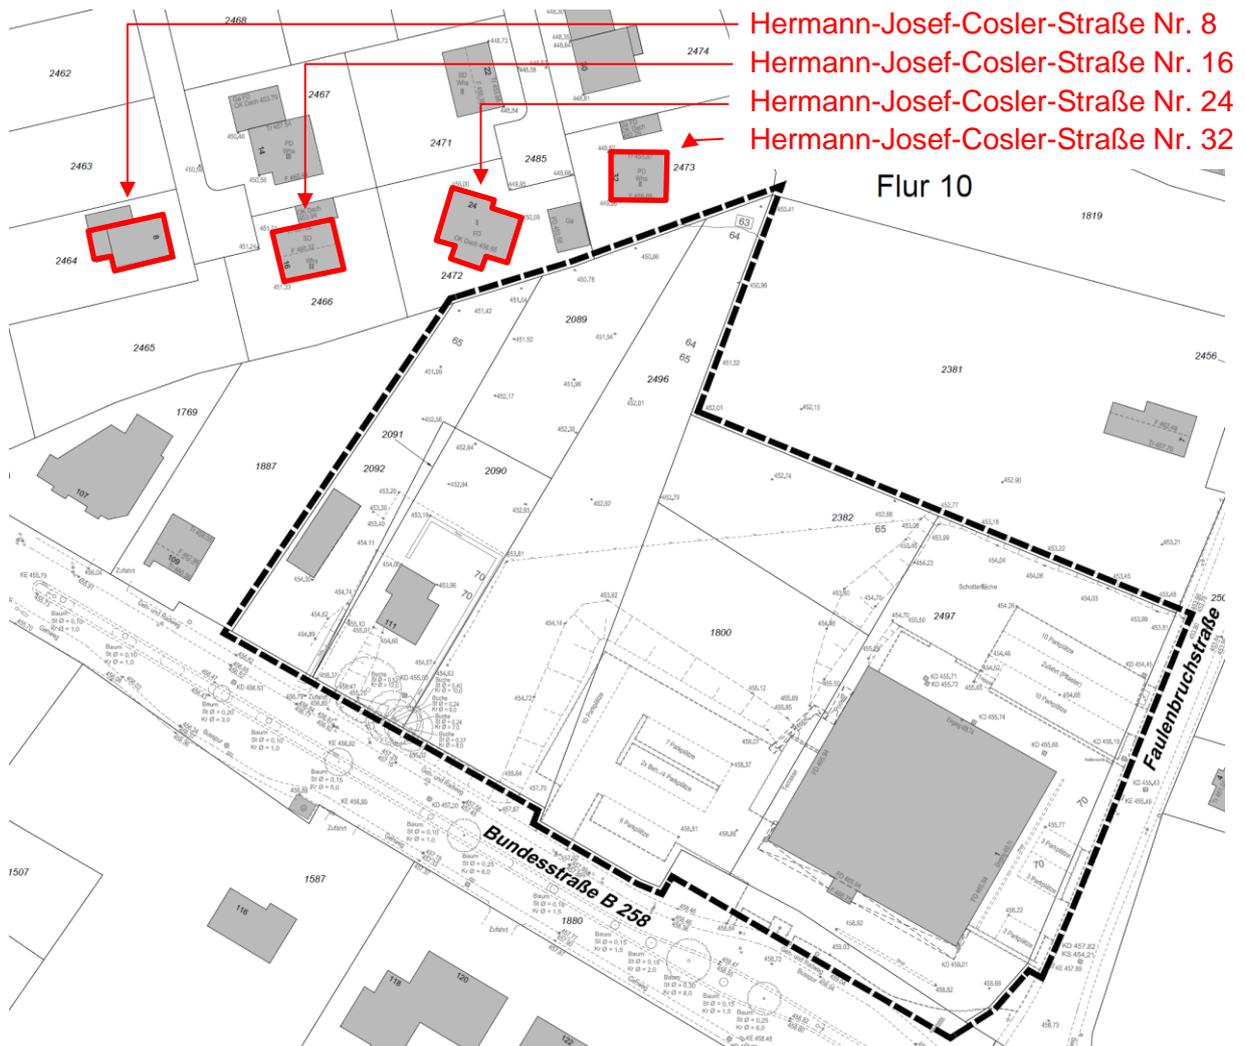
Vermessungsgrundlage Plangebiet, Darstellung der betrachteten Nachbargebäude
